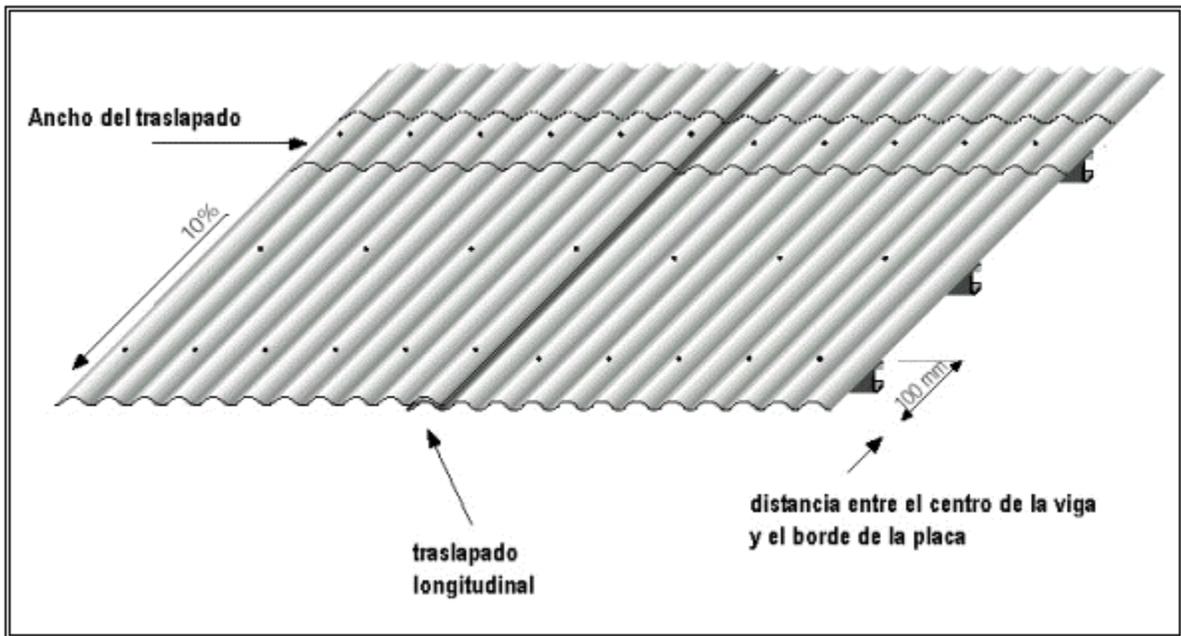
Traslapados en placas de policarbonato ondulado.
